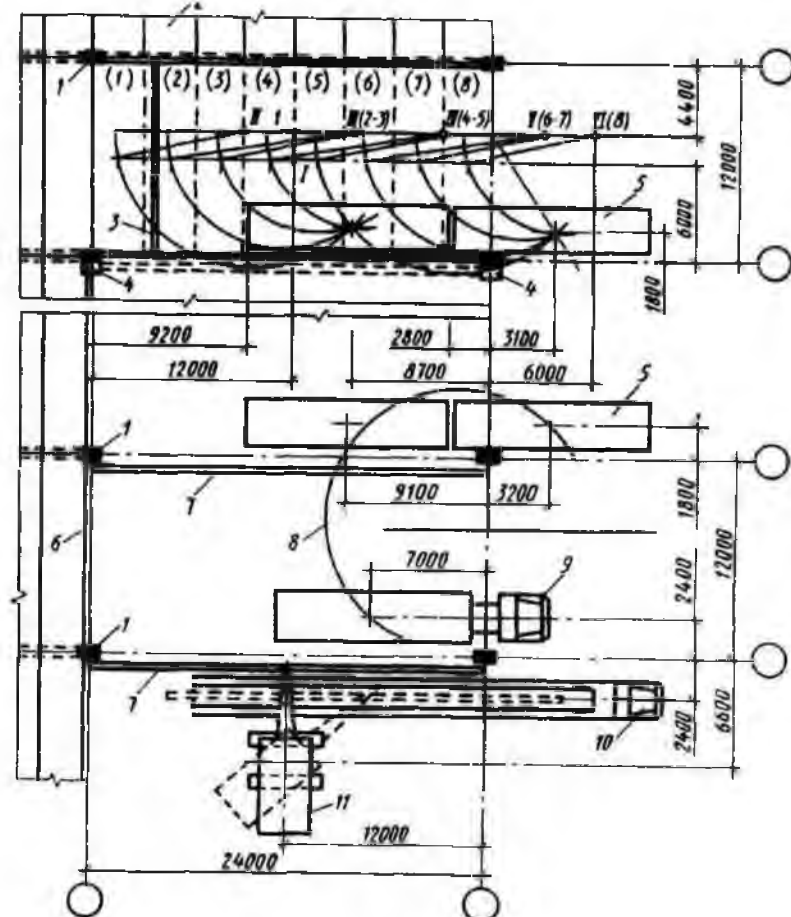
Схема выгрузки, раскладки элементов и монтажа покрытия пролетом 24 м поперечным методом:
